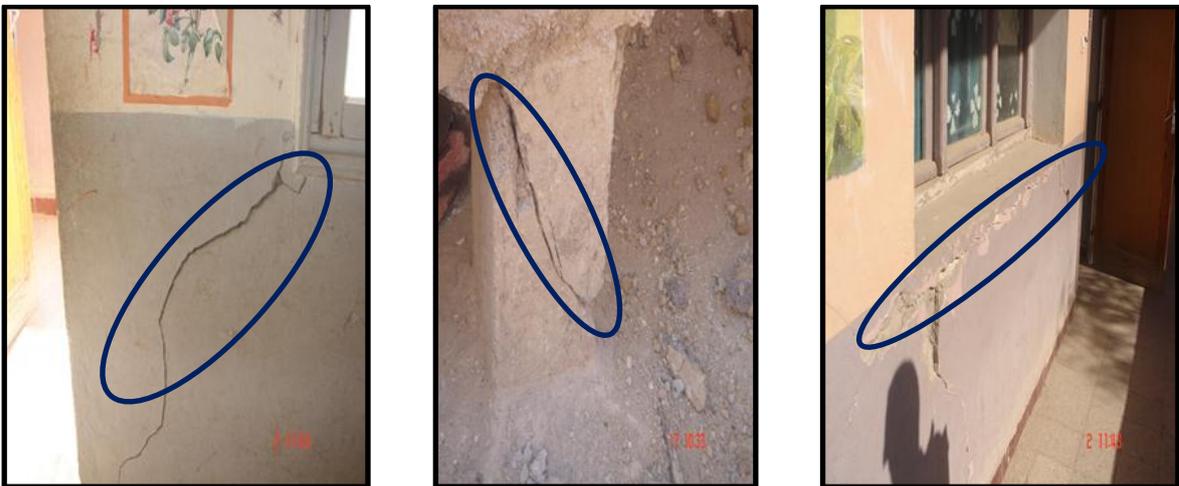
Type de fissuration (école Ibn Baytar)
